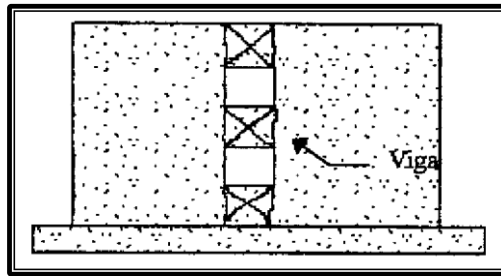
Grietas a 45 ° formando una X que unen las dos porciones del muro (Fallas por tensión diagonal en las vigas de unión)
